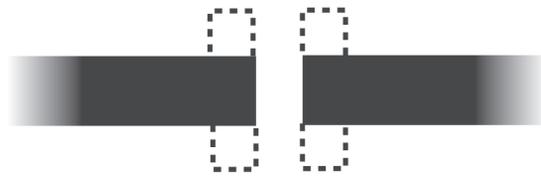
Schematischer Grundriss Typ 1.0.1
